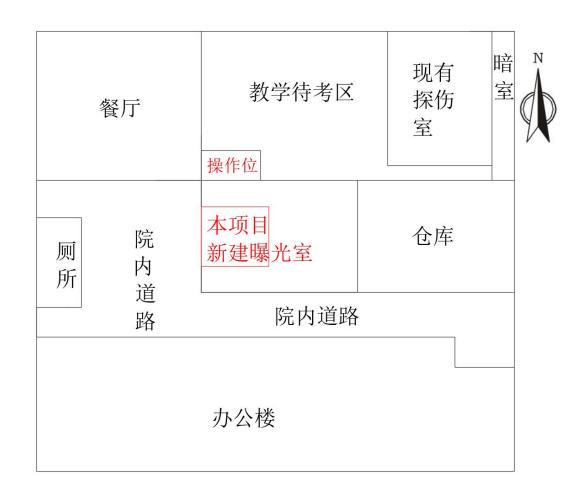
潍坊佳禾职业培训学校总平面布置示意图
